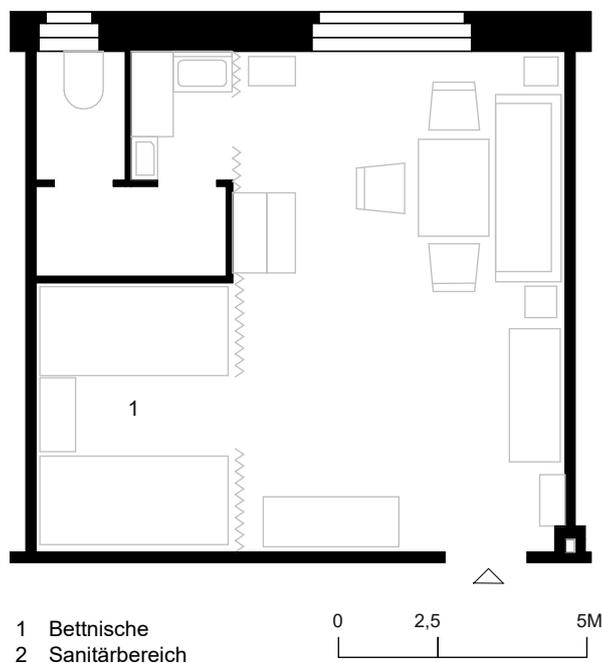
Grundriss Einzimmerwohnung, Heimhof, 1926
